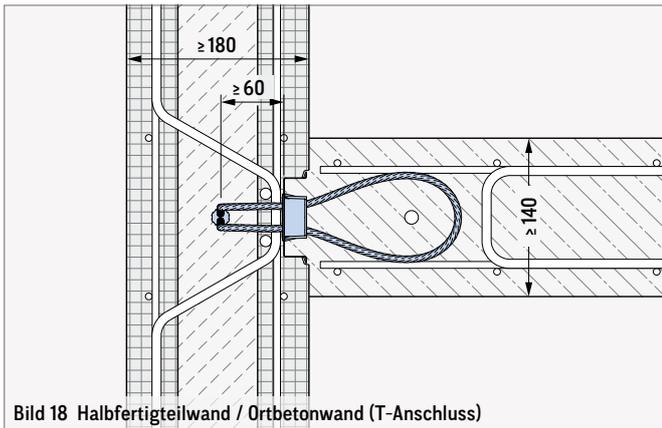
Halbfertigteilwand / Ortbetonwand (T-Anschluss)
